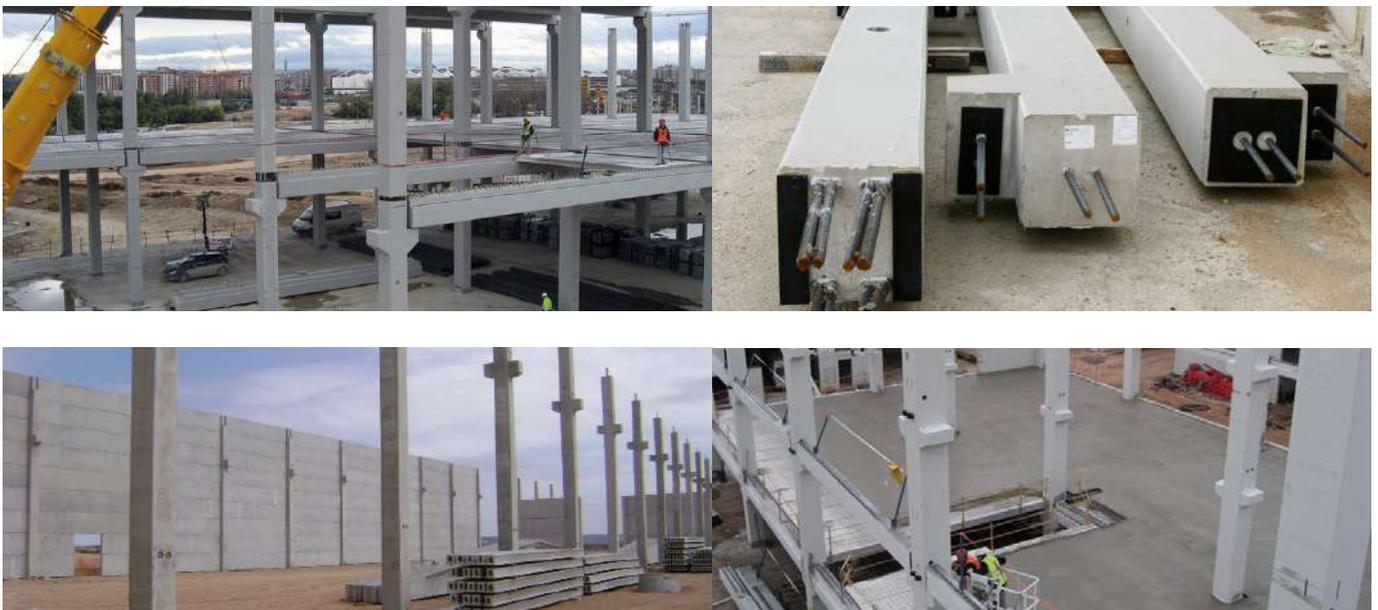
Diferentes tipos de pilares prefabricados de hormigón, y las uniones planteadas con las vigas también prefabricadas de hormigón.
